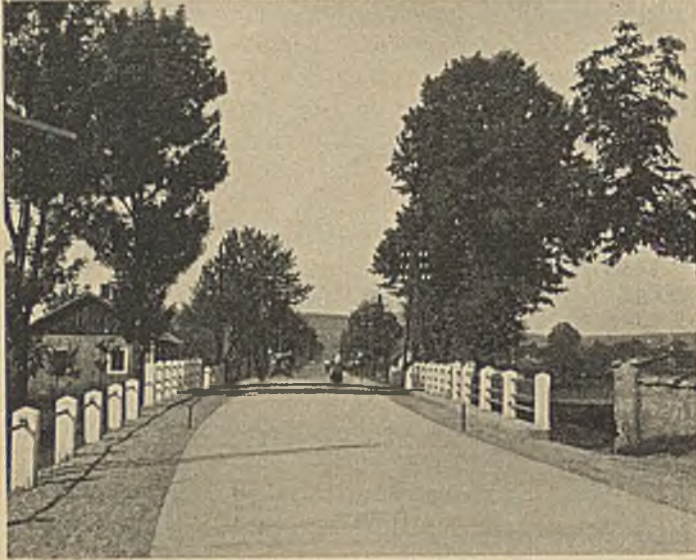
Eisenbetonbalkenbrücke von etwa 16 m Spannweite im Zuge der Betonstraße Strecke I.
